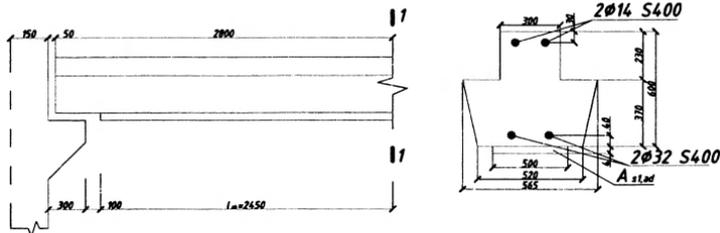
К расчету усиления растянутой зоны наклейкой дополнительной арматуры
